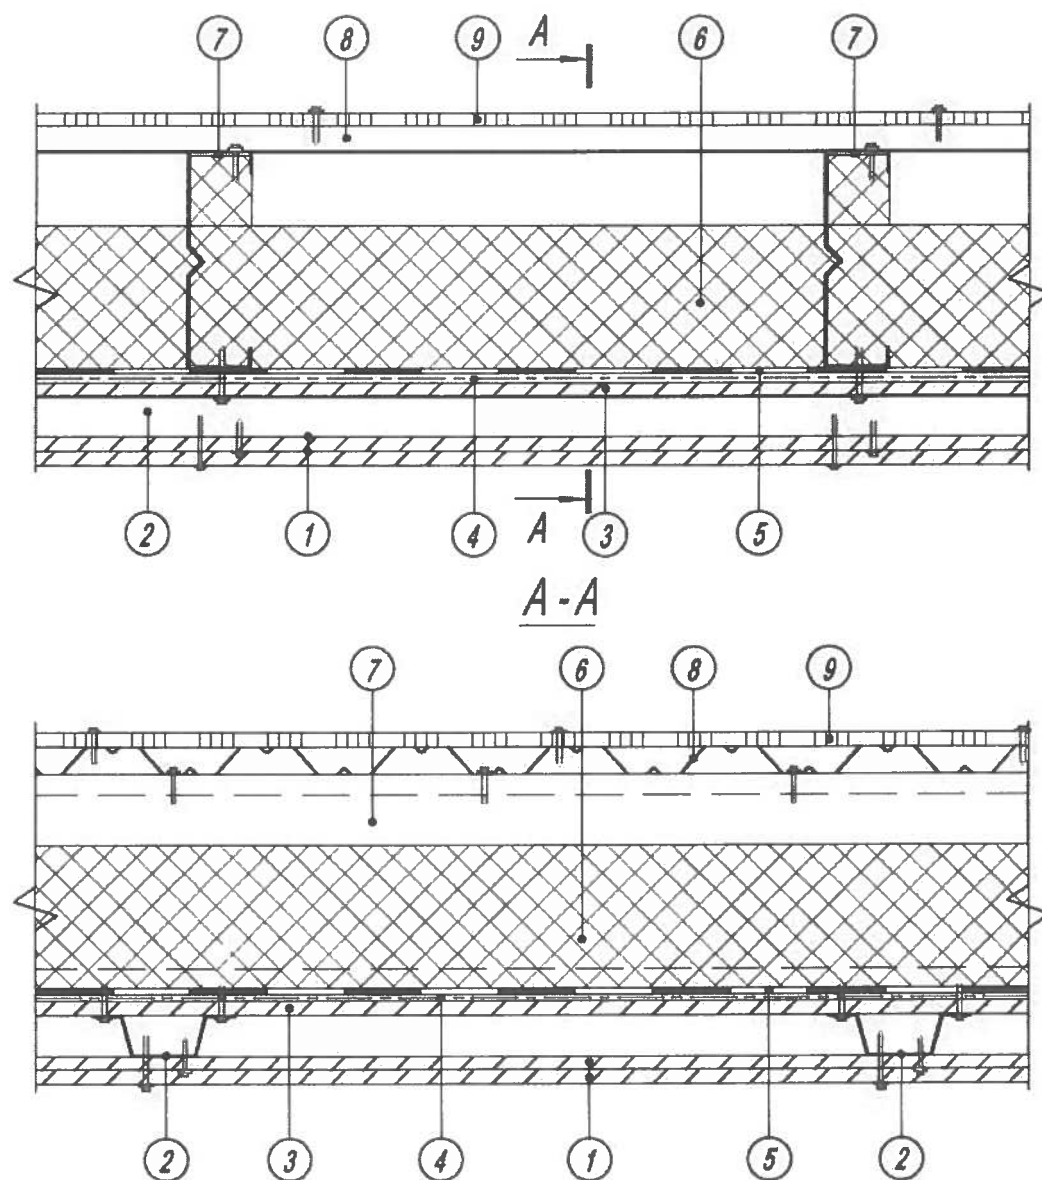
Принципиальная схема конструктивного исполнения междуэтажного перекрытия (тип 1)
